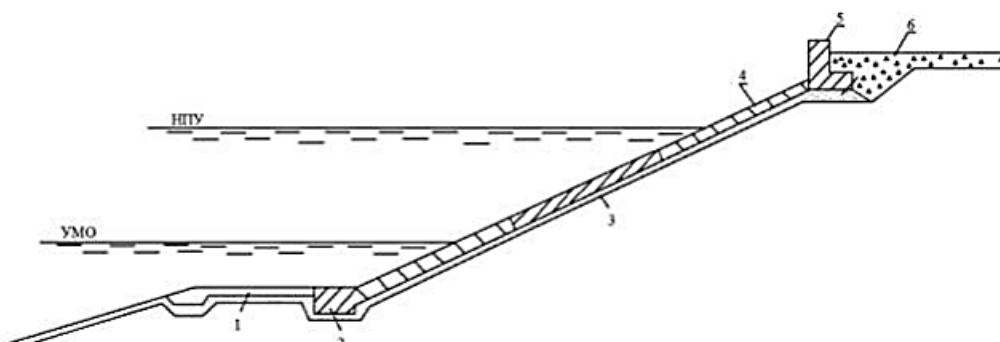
Пример конструкции откосного сборного крепления с применением железобетонных плит: 1 – облегченное крепление; 2 – упор основного крепления; 3 – подготовка слоистая или однослойная; 4 – основное покрытие из плит с открытыми швами; 5 – парапет; 6 – засыпка из рядового щебня [31]
